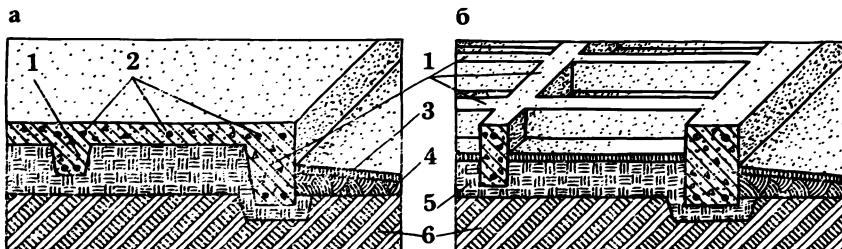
Платные (плавающие) фундаменты, устраиваемые на пучинистых, горизонтально-подвижных и просадочных грунтах
